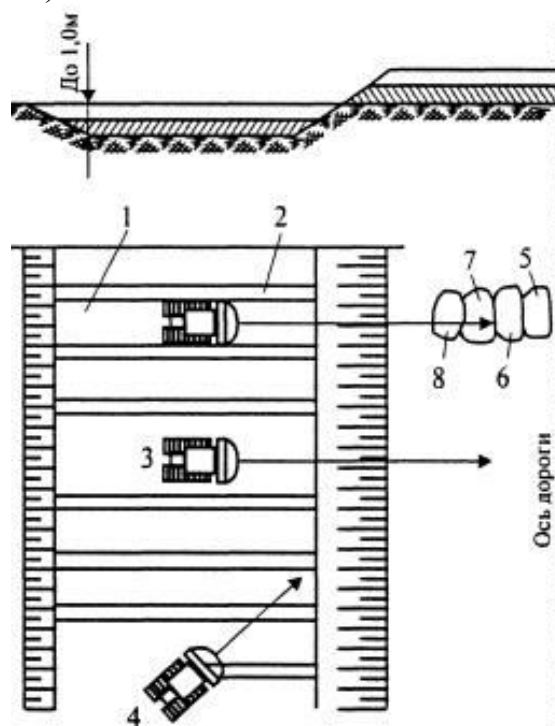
Траншейный способ разработки грунта при отсыпке насыпи: 1 – траншея; 2 – стенки траншеи; 3, 4 – срезка стенок траншеи соответственно поперечными и косыми проходами; 5–8 – объемы перемещаемого грунта
